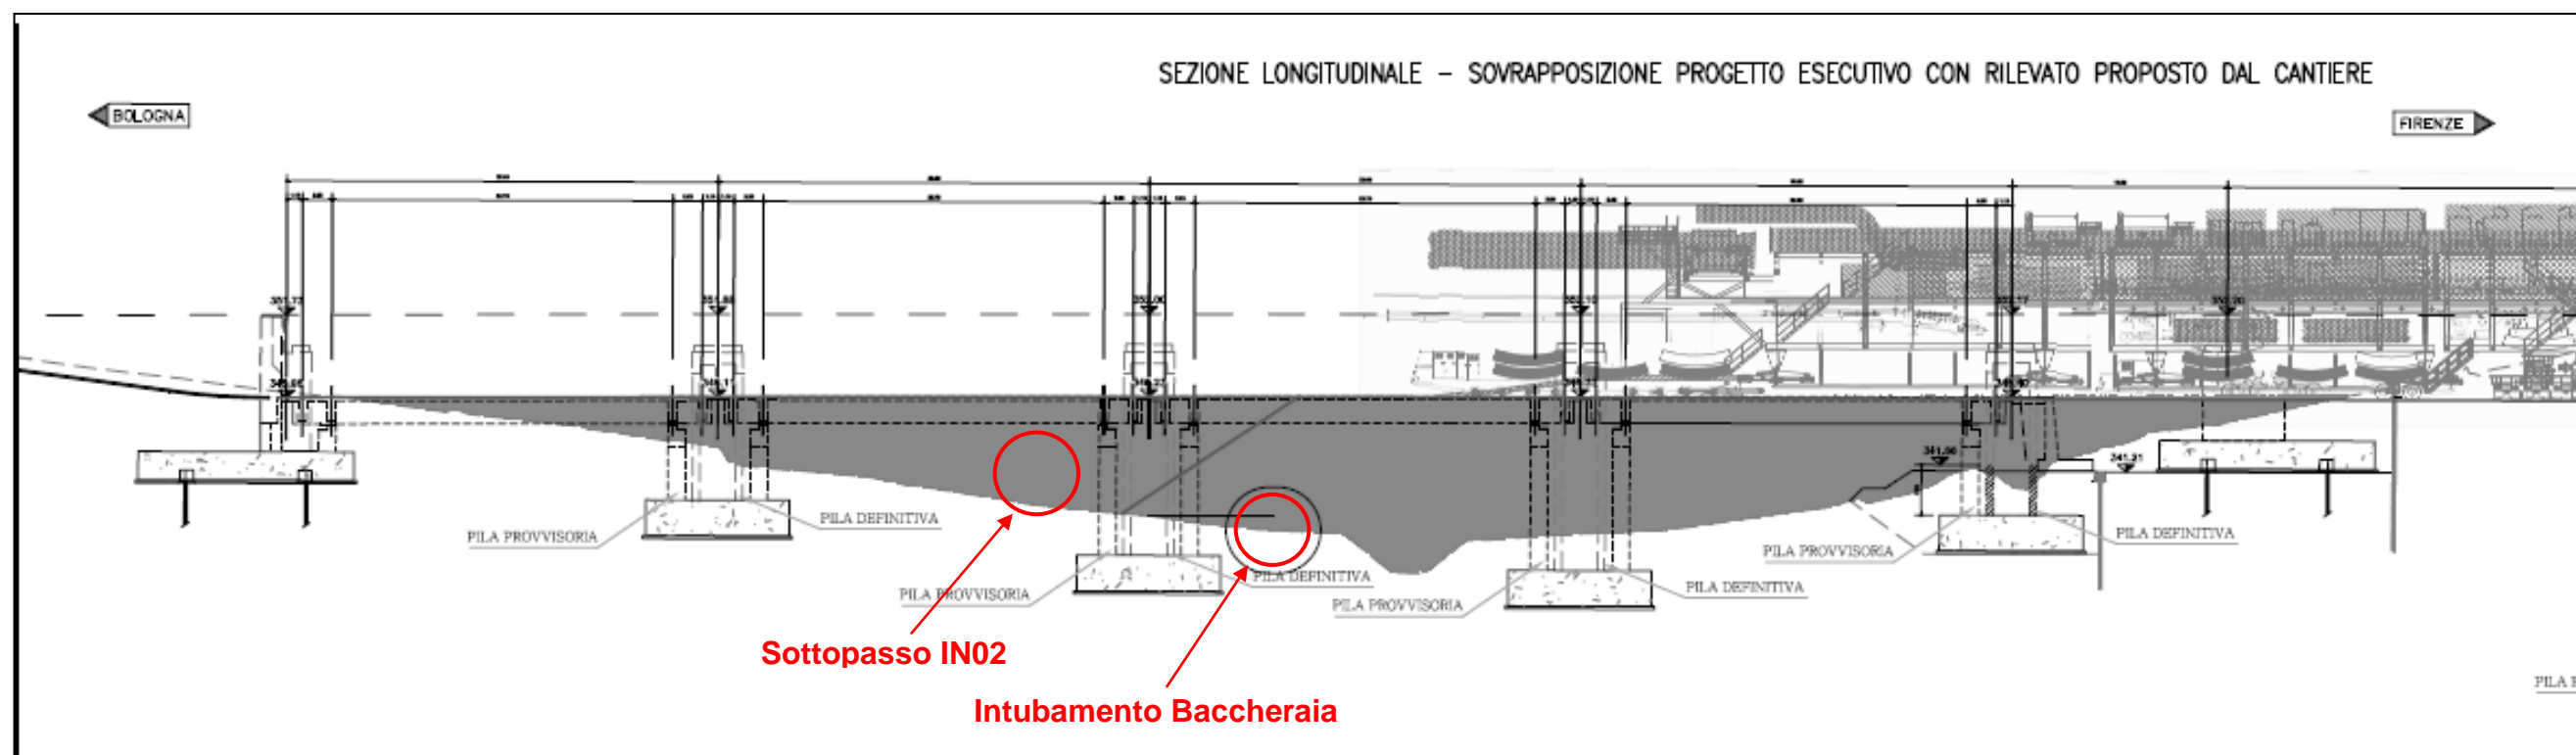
sezione longitudinale del viadotto Baccheraia nella variante proposta, nella fase di cantierizzazione e di attività della fresa
